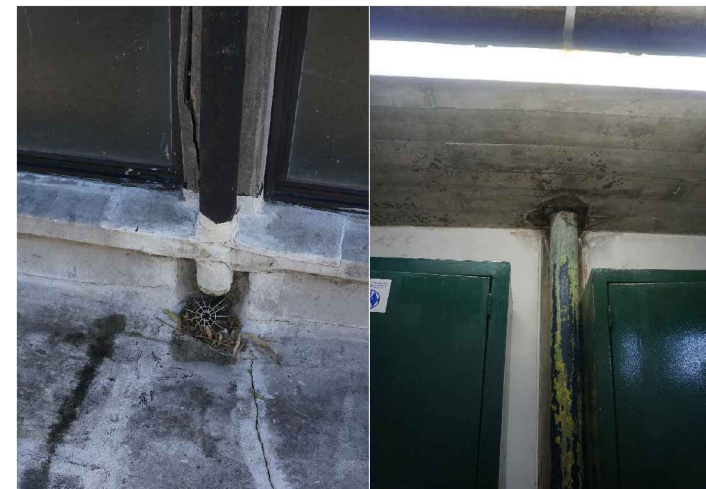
BAJADA DE PLUVIALES S3.3
